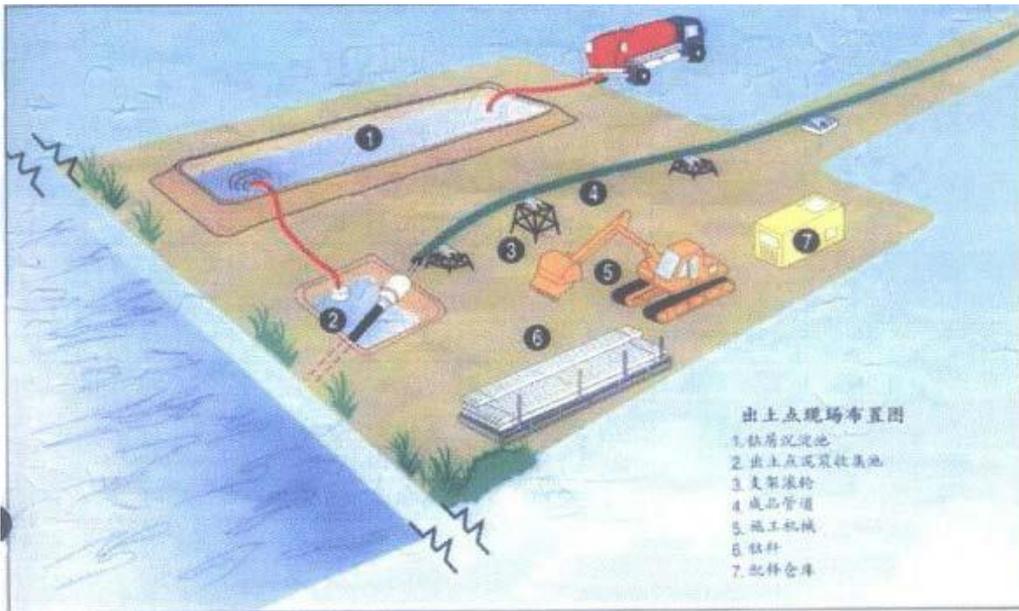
定向钻施工场地平面布置图（出土侧）
